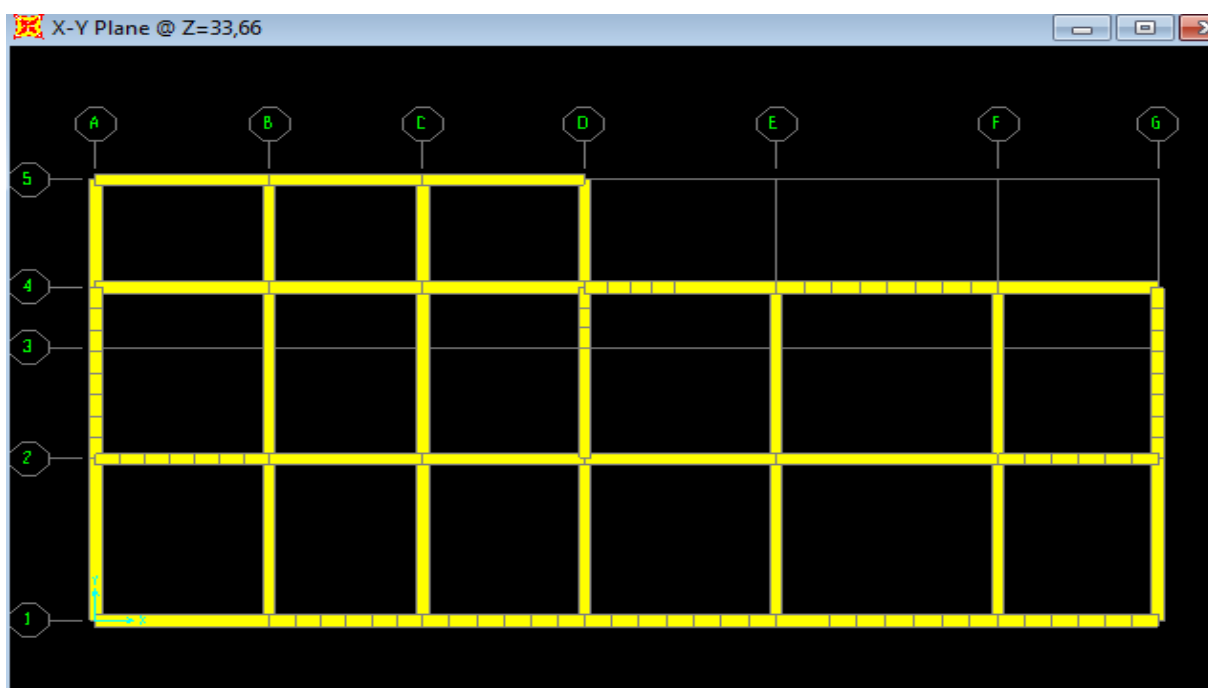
plancher à corps creux (terrasse inaccessible)
